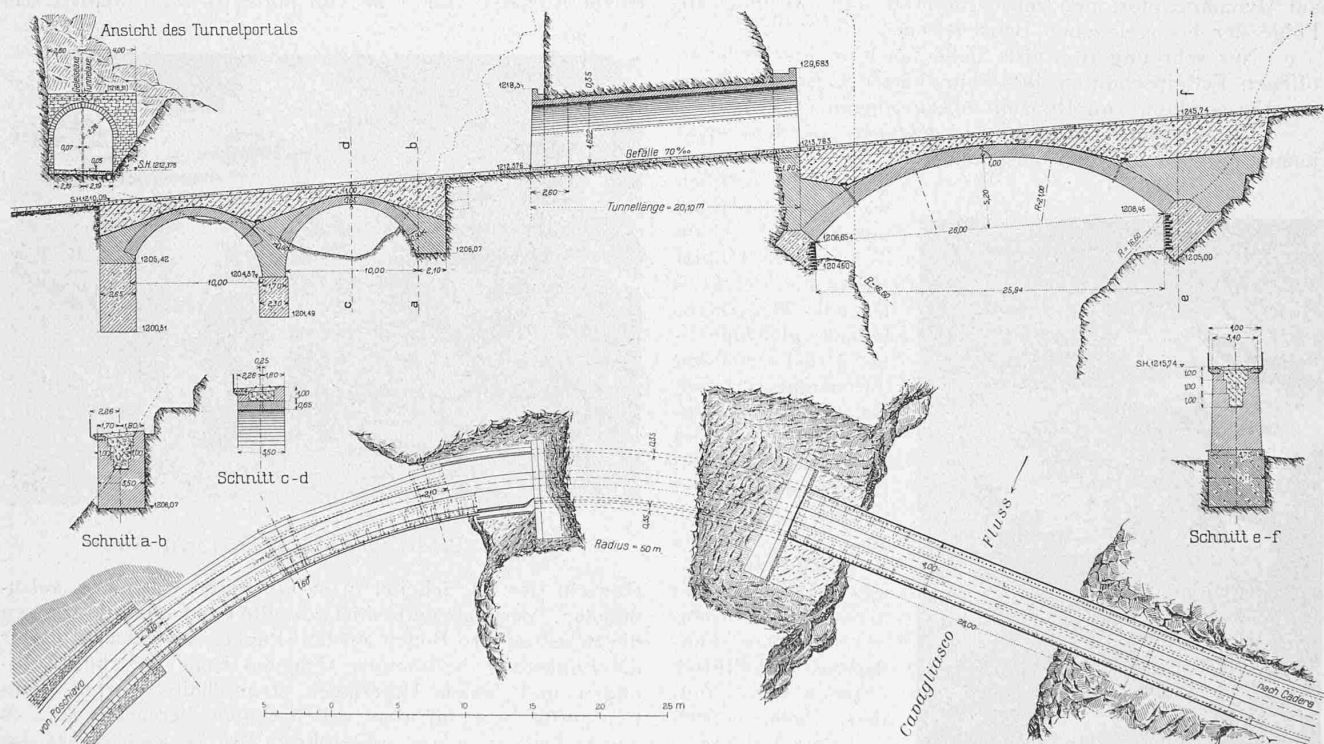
Lehnenviadukt bei Km. 40,8 mit anschliessendem Tunnel und untere Cavagliascobrücke. — Grundriss und Schnitte. — 1:500.
